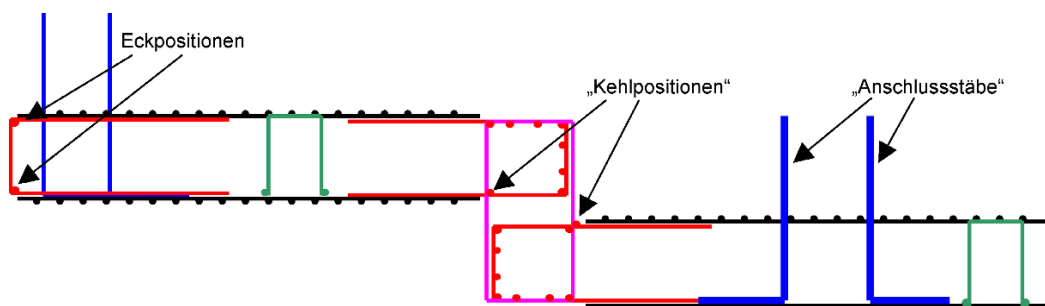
Prinzip einer Bodenplatte mit Absatz und allen erforderlichen 3 Biegeformen plus der Matte oben und unten
